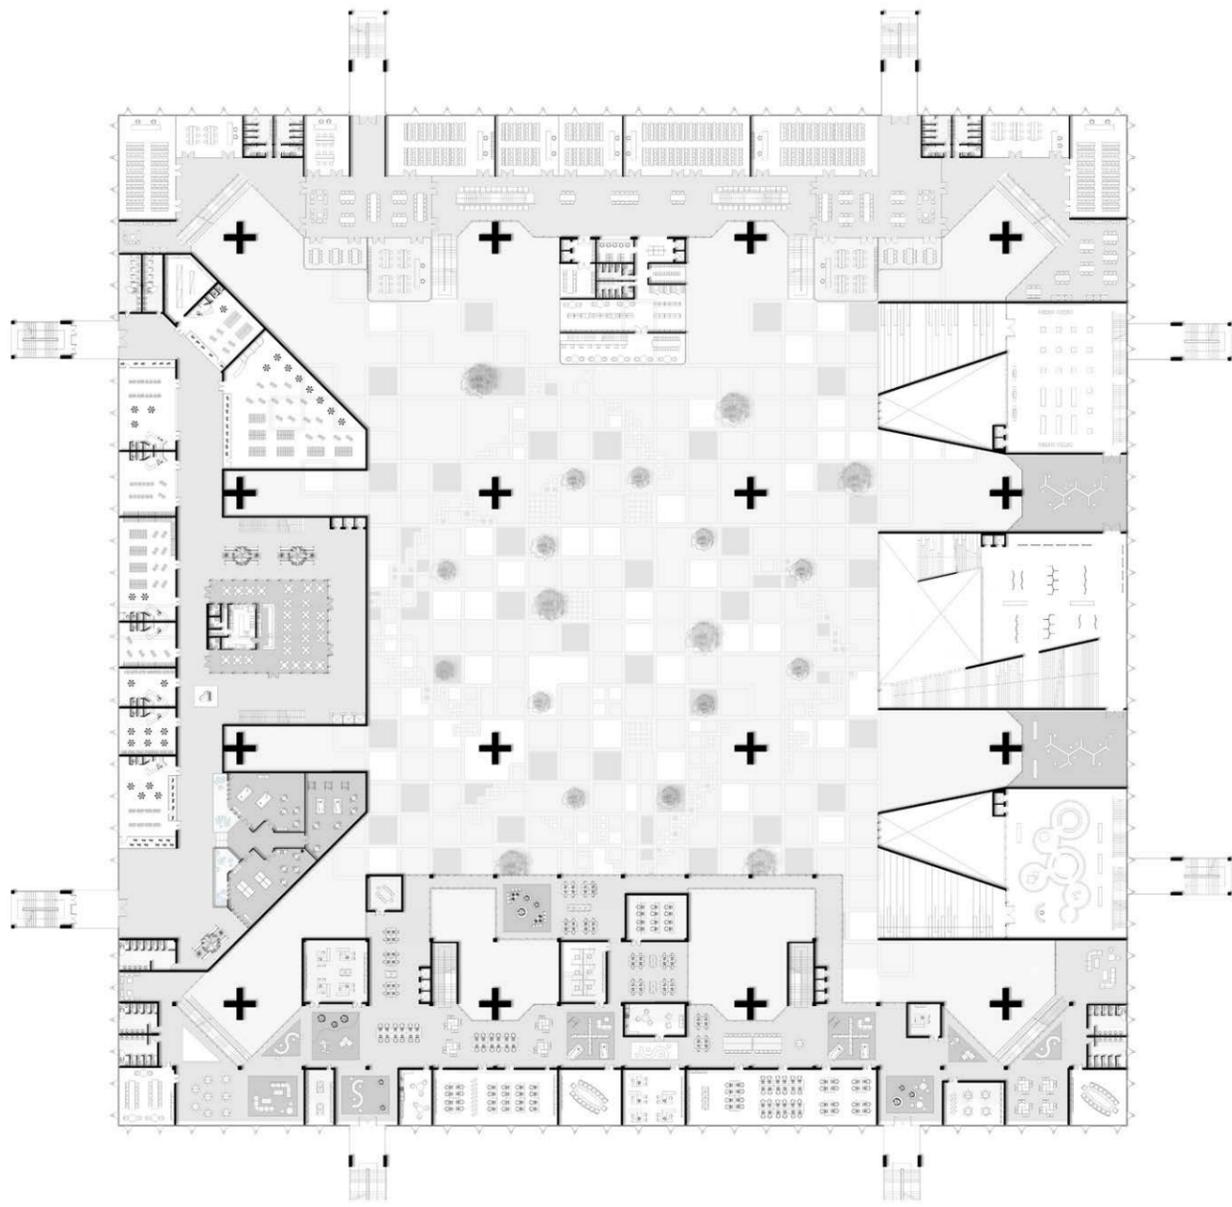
Pianta piano secondo dell'intervento Eccezioni alla Regola, elaborato degli autori. Scala 1:1000
